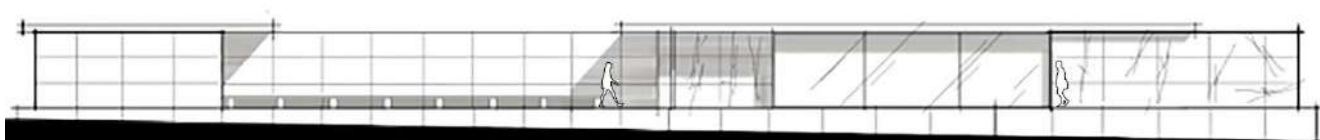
| “Pavilhão de Barcelona”, Corte Longitudinal (Fonte: Blog Adriarq, 2014). Modificado pela autora, 2024.
